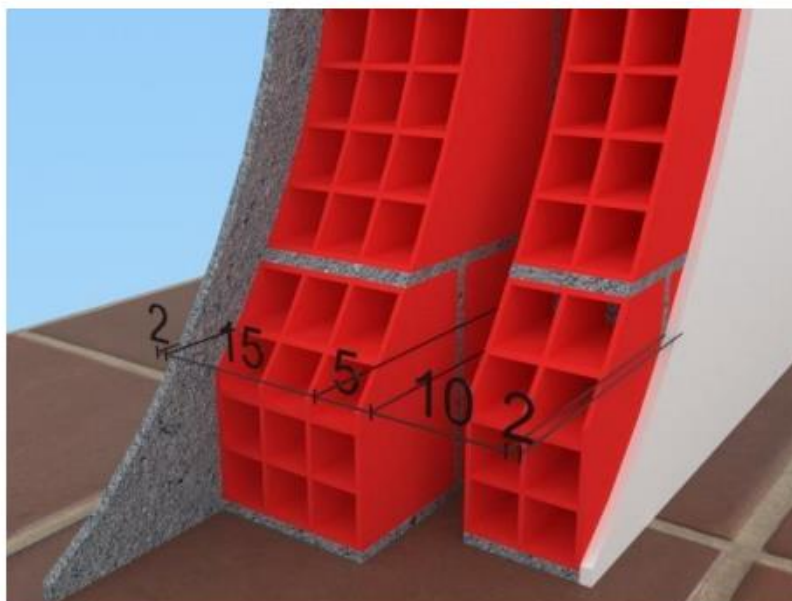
Coupe Verticale 3D D'un Mur Extérieur
